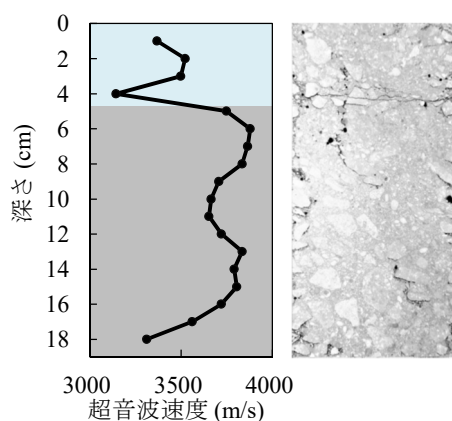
採取コアの超音波速度と水平ひび割れの状況
